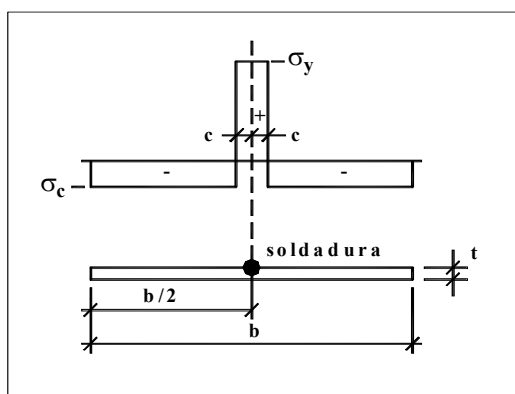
"Autotensiones en chapas soldadas."
